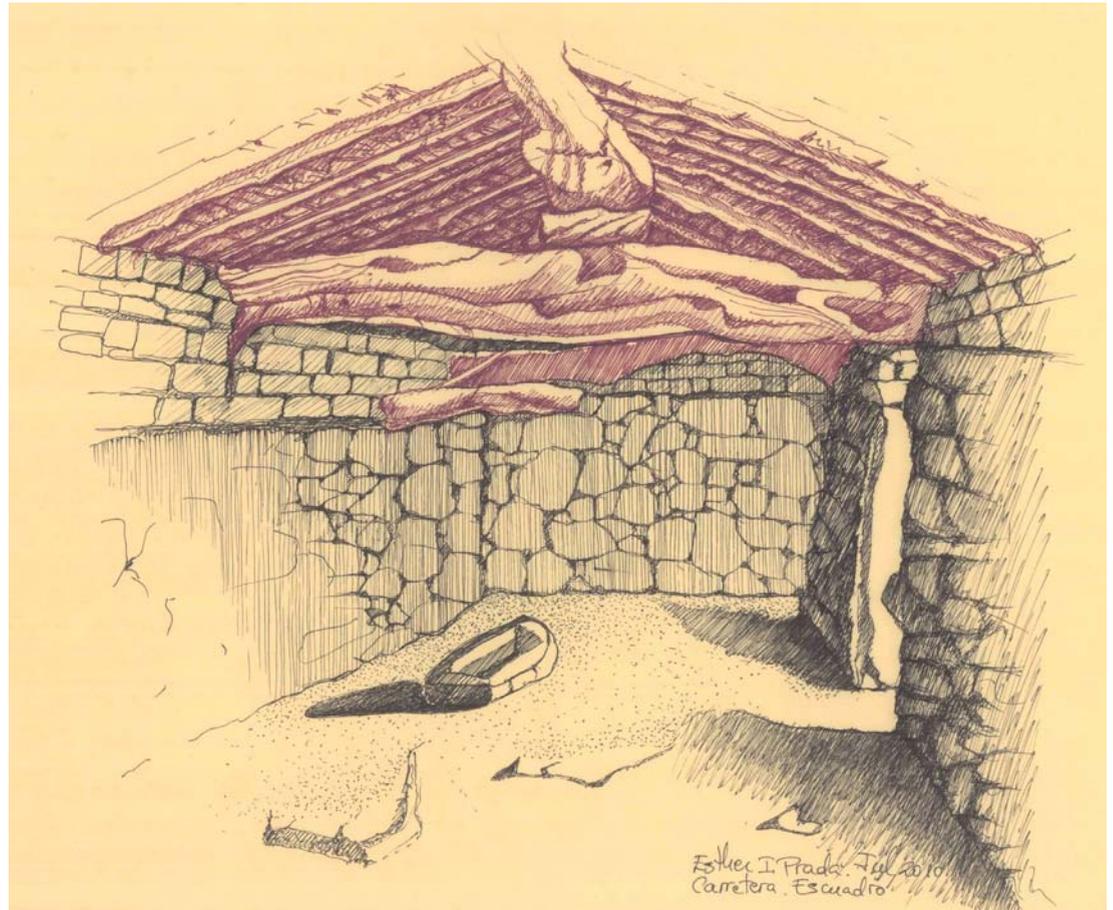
"Carretera" o tenada. Construcción de muros en piedra seca y adobe, cubierta con cabrios de madera y teja superpuesta. Sayago. Dibujo a tinta.
